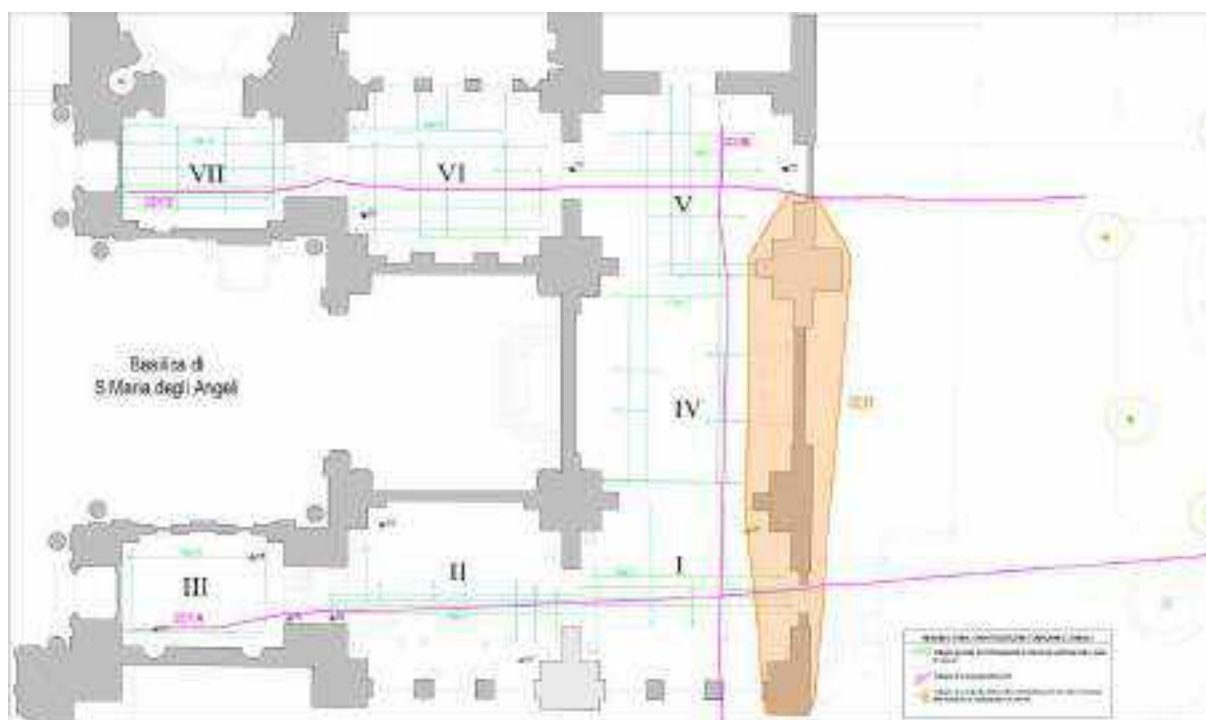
Planimetria con distribuzione finale delle prove eseguite.
